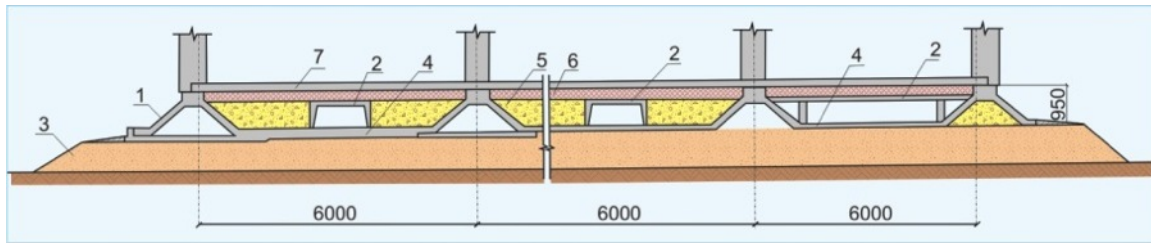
Конструкция поверхностного пространственного фундамента-оболочки в сочетании с вентиляционными каналами:
